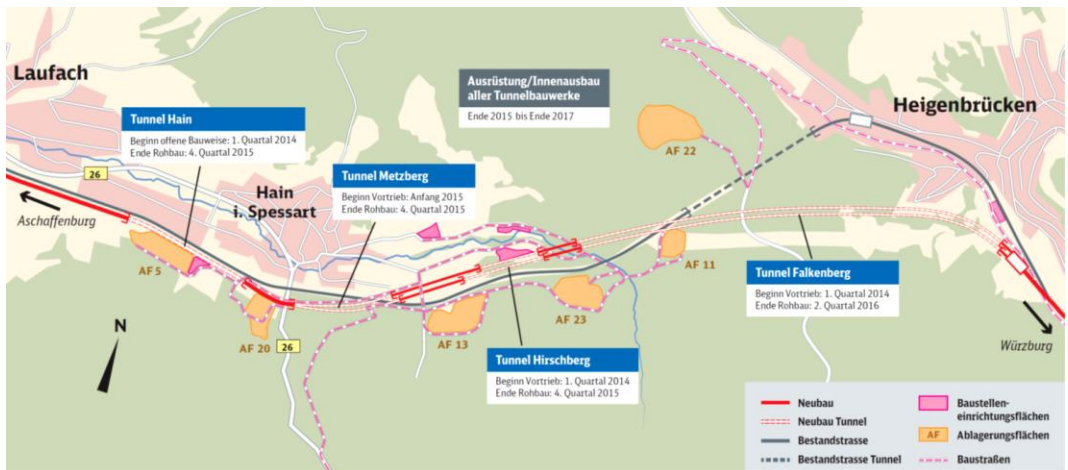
Lageplan der Bauwerke im Streckenabschnitt Laufach-Heigenbrücken, aus: [DB Projekt GmbH, 2013]
